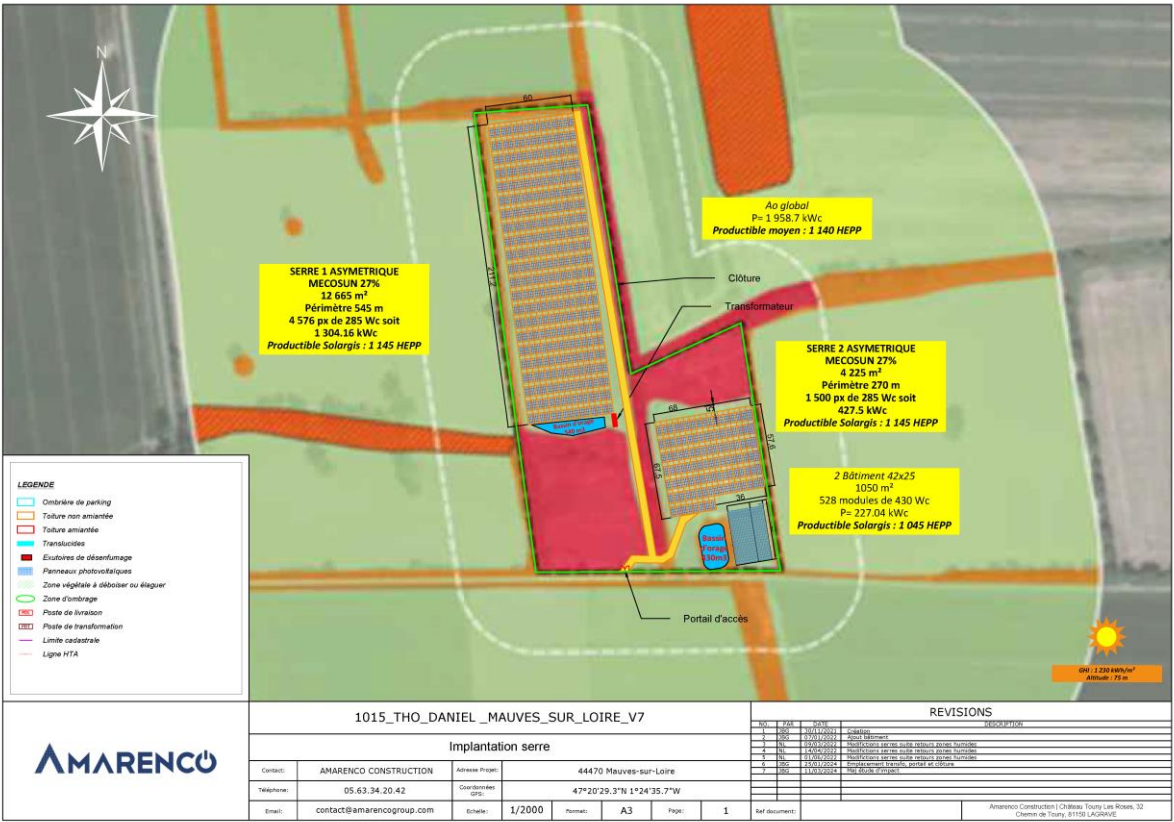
Plan implantation – Scénario retenu – Juin 2024 – THO Daniel (Source : AMARENCO)
